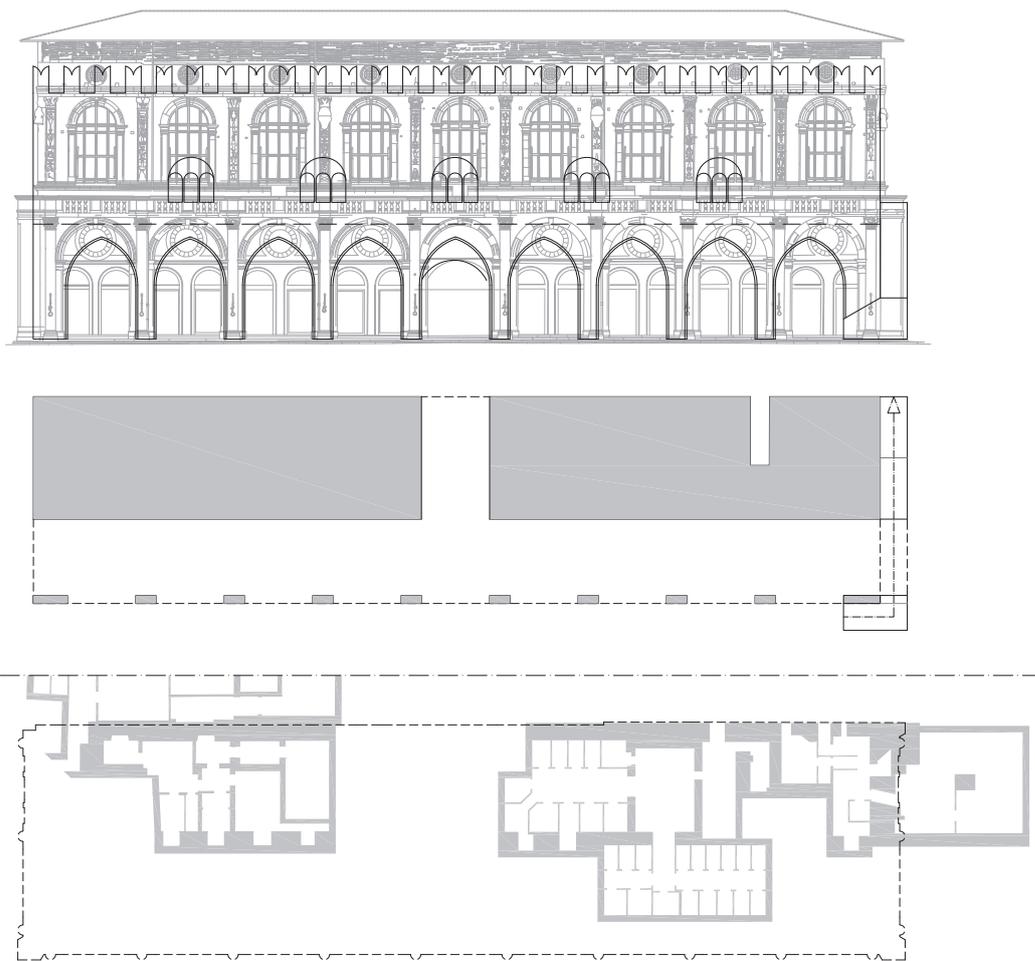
Ricostruzione schematica del prospetto e della pianta originali, ricavabili in parte dal rilievo degli ambienti interrati.
